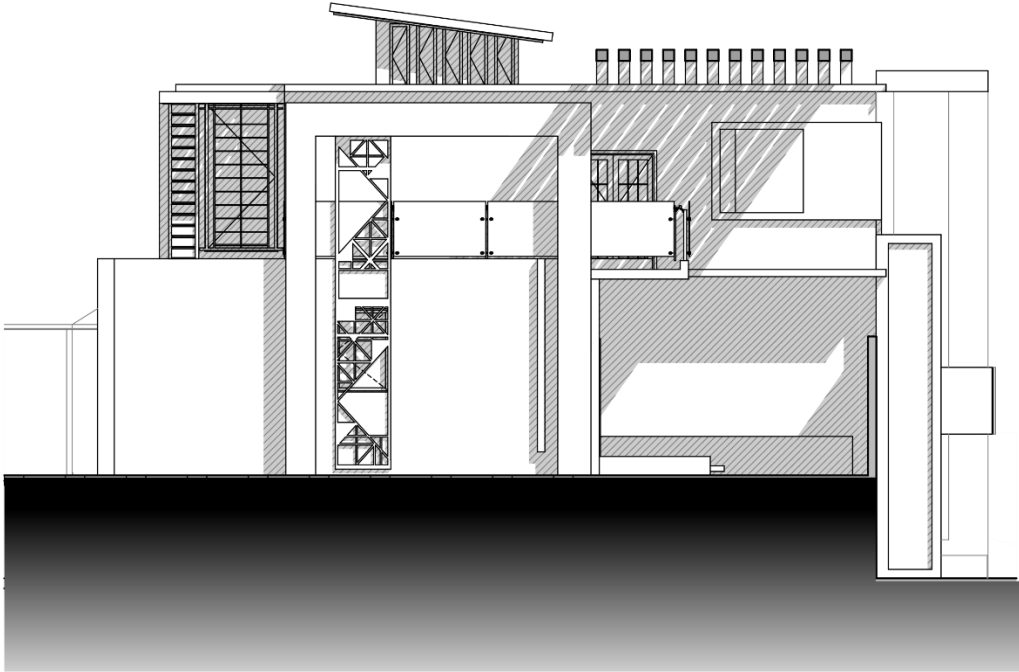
Façade latérale 2 sans clôture ech 1/100.
